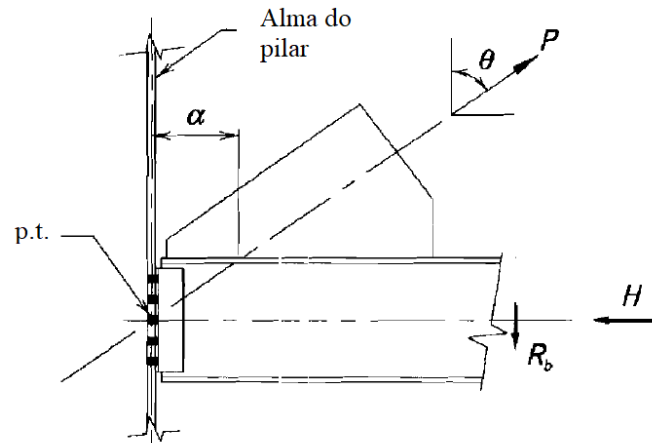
Ligação de viga e contraventamento com coluna. Adaptada (AISC, 2007, p. 13-9)
